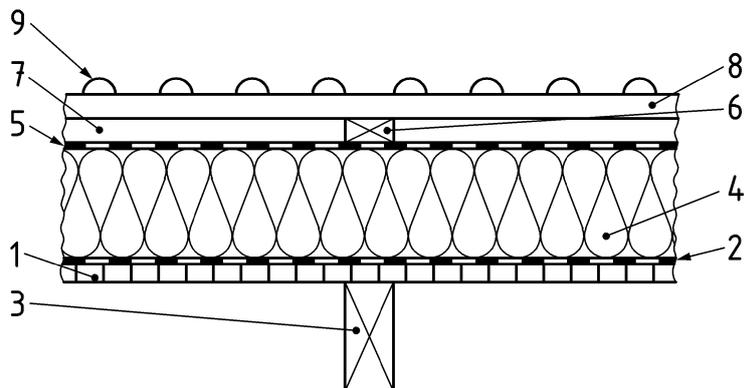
Querschnitt des flach geneigten oder geneigten Daches, voll gedämmte und nicht belüftete Dachkonstruktionen (Prinzip)
